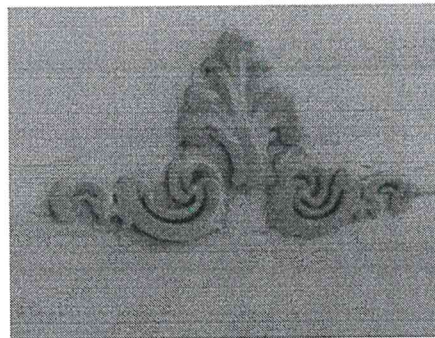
Ozdobne obramowanie otworu drzwiowego.
